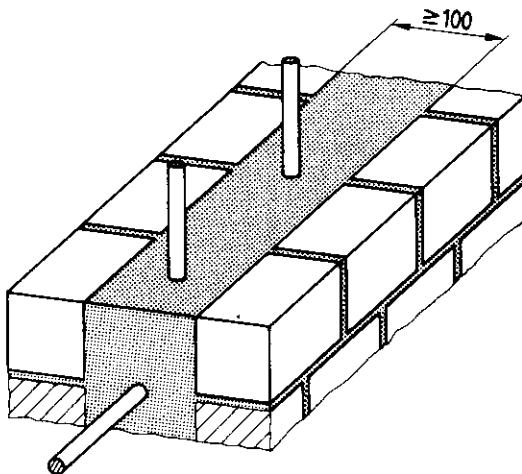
Bewehrung in durchgehenden, ummauerten Aussparungen (Prinzipskizze)
